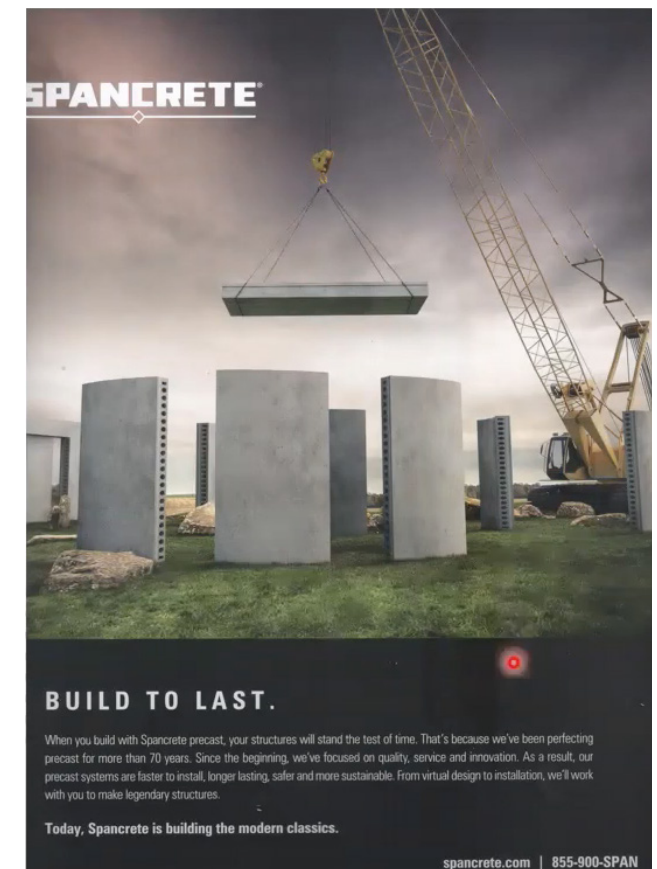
Sistemas modulares prefabricados de hormigón. Fuente: Spancrete.com(2021)
